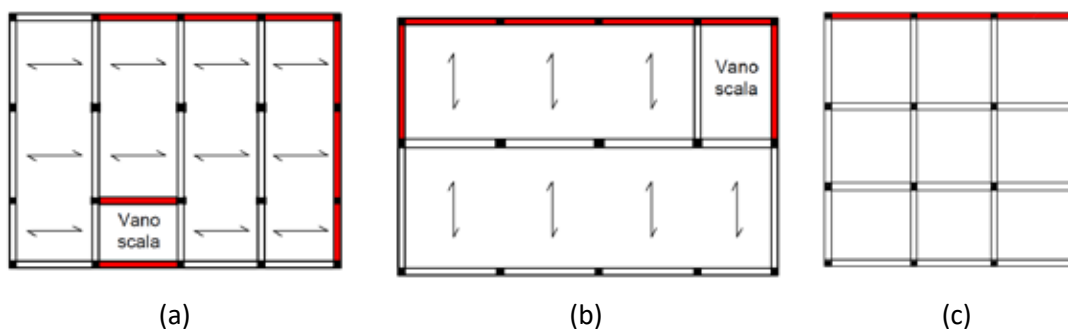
Distribuzione dei tamponamenti non simmetrica in pianta di edifici con struttura a telaio in c.a.
